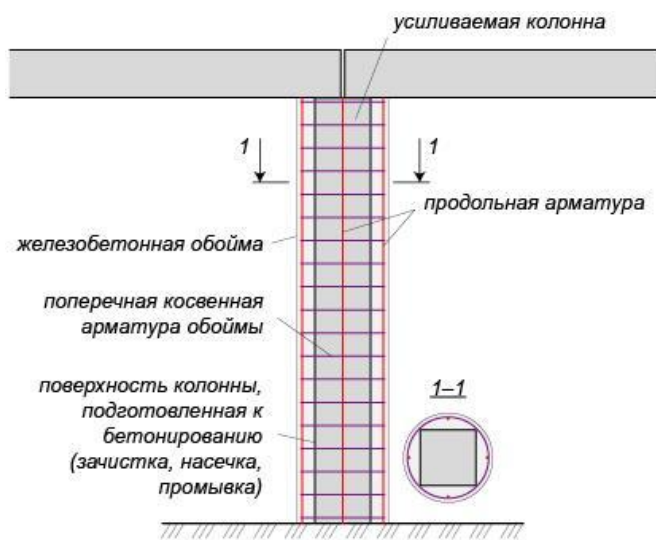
Устройство железобетонной обоймы при усилении железобетонной колонны
